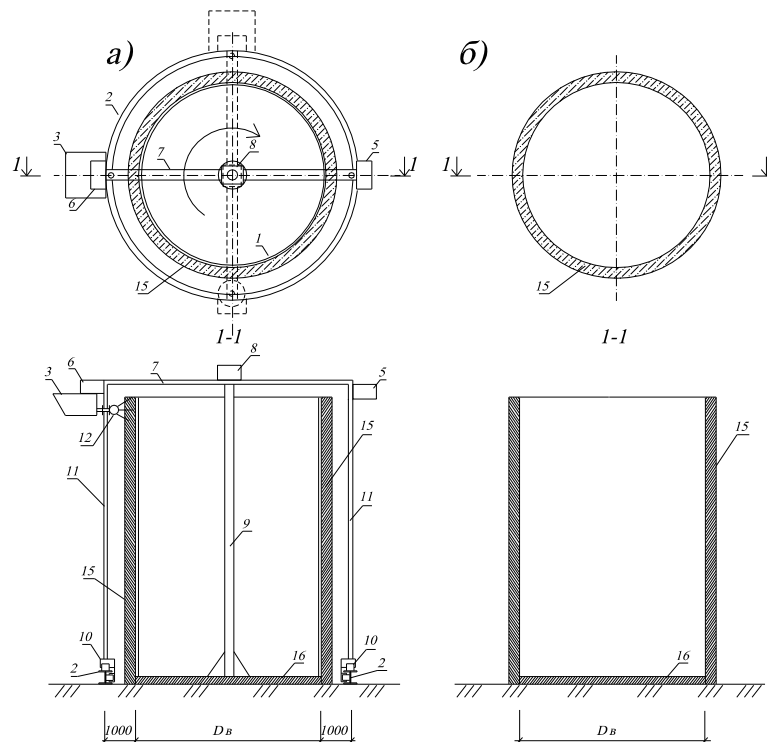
Окончание процесса возведения резервуара: а)- устройство второго слоя резервуара; б)- резервуар после распалубки; 1- внутренняя опалубка резервуара; 2- роликовые пути; 3- торкрет-установка; 4- бухта арматурной сетки; 5- механизм подъема бухты; 6- механизм подъема торкрет-установки; 7- портал; 8- механизм вращения портала; 9- центрирующая стойка; 10- горизонтальный и вертикальный ролики; 11- стойка портала; 12- сопло торкрет-установки; 13- гибкие тяги; 14- первый слой торкрет бетона; 15- второй слой торкрет бетона; 16- днище резервуара;  $D_B$ - внутренний диаметр резервуара
